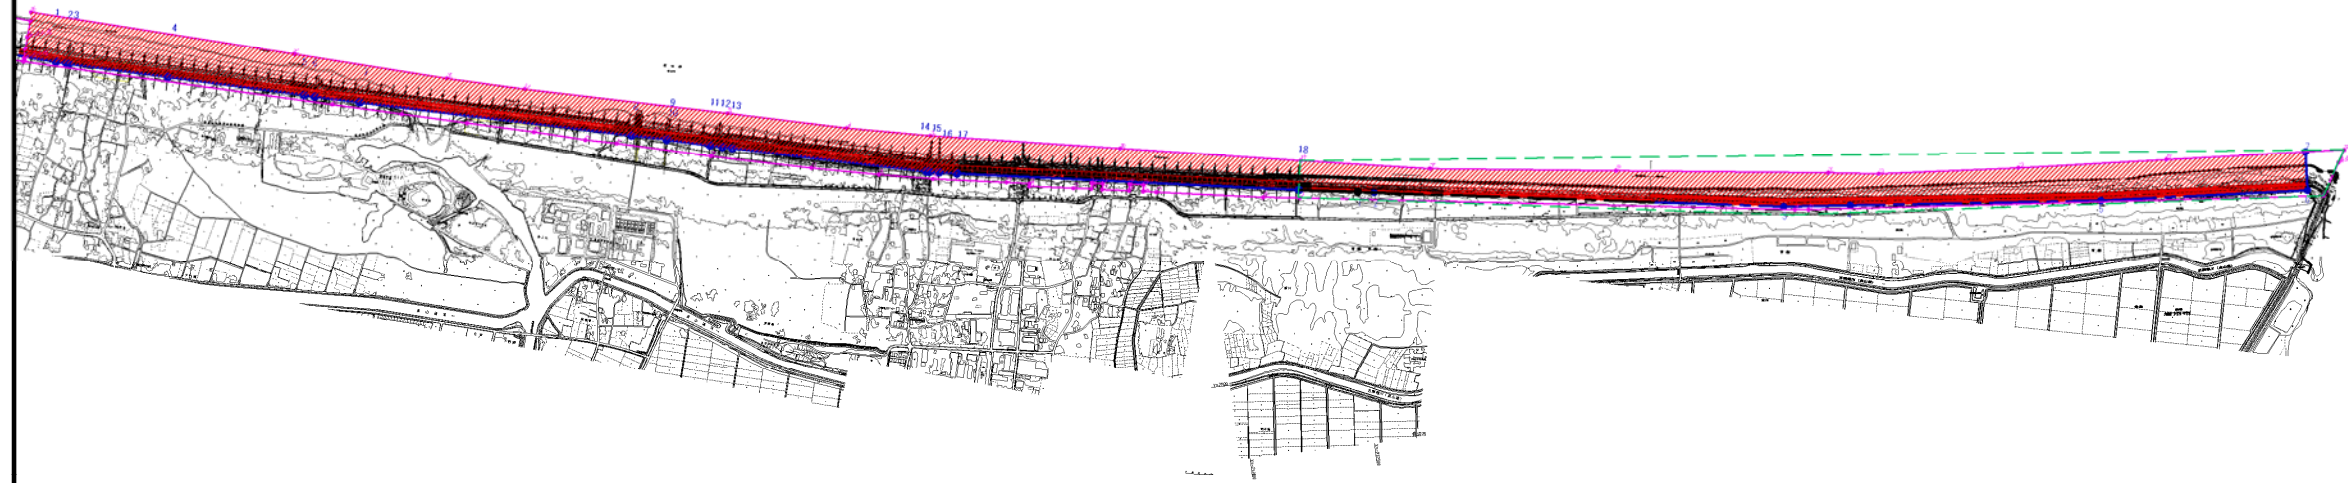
海岸保全区域平面図(岩沼海岸)
